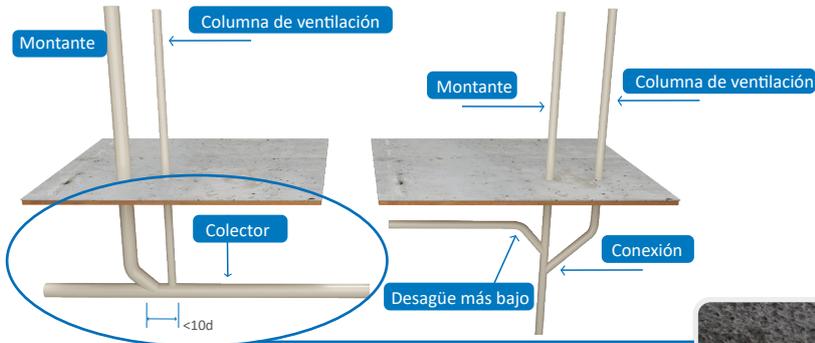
Conexiones entre columnas de desagüe y ventilación en la base de la edificación.
